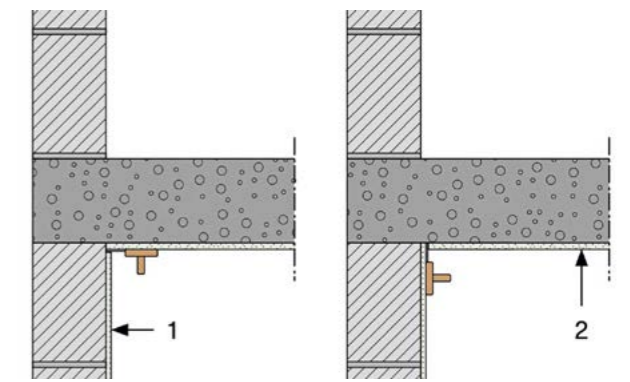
Réalisation d'une incision visant à désolidariser l'enduit mural de l'enduit de plafond
